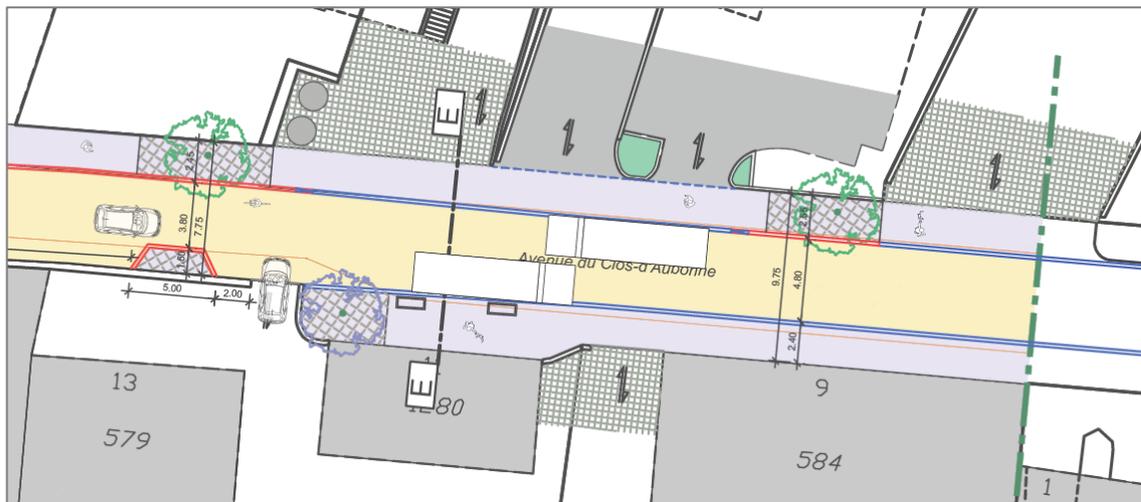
schéma illustratif des abords du local associatif, fond de plan extrait du plan MCR
